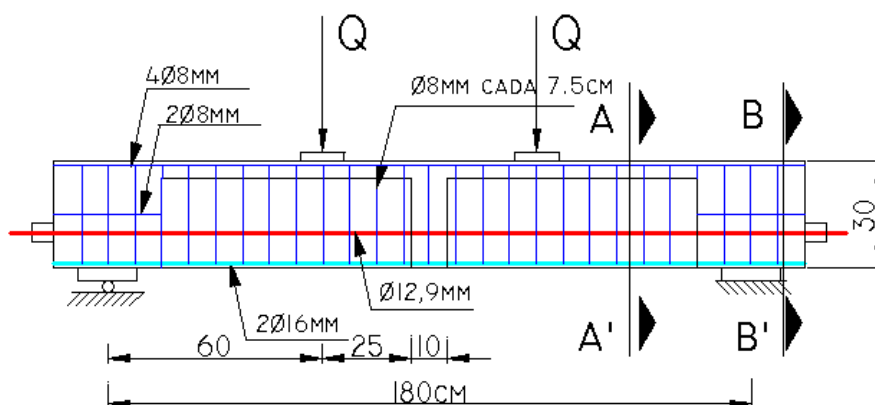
Detalhamento da viga de Tan e Ng (1998)
